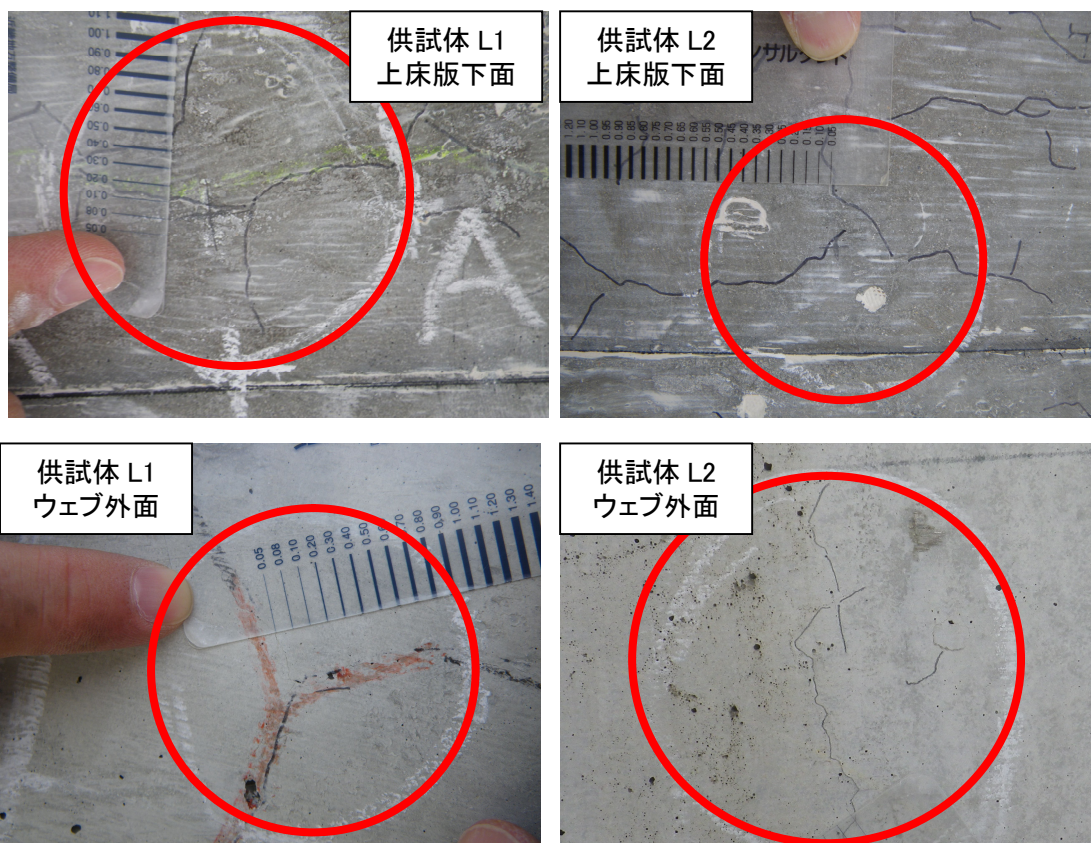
供試体 L1, L2 コア抜き位置のひび割れ状況
